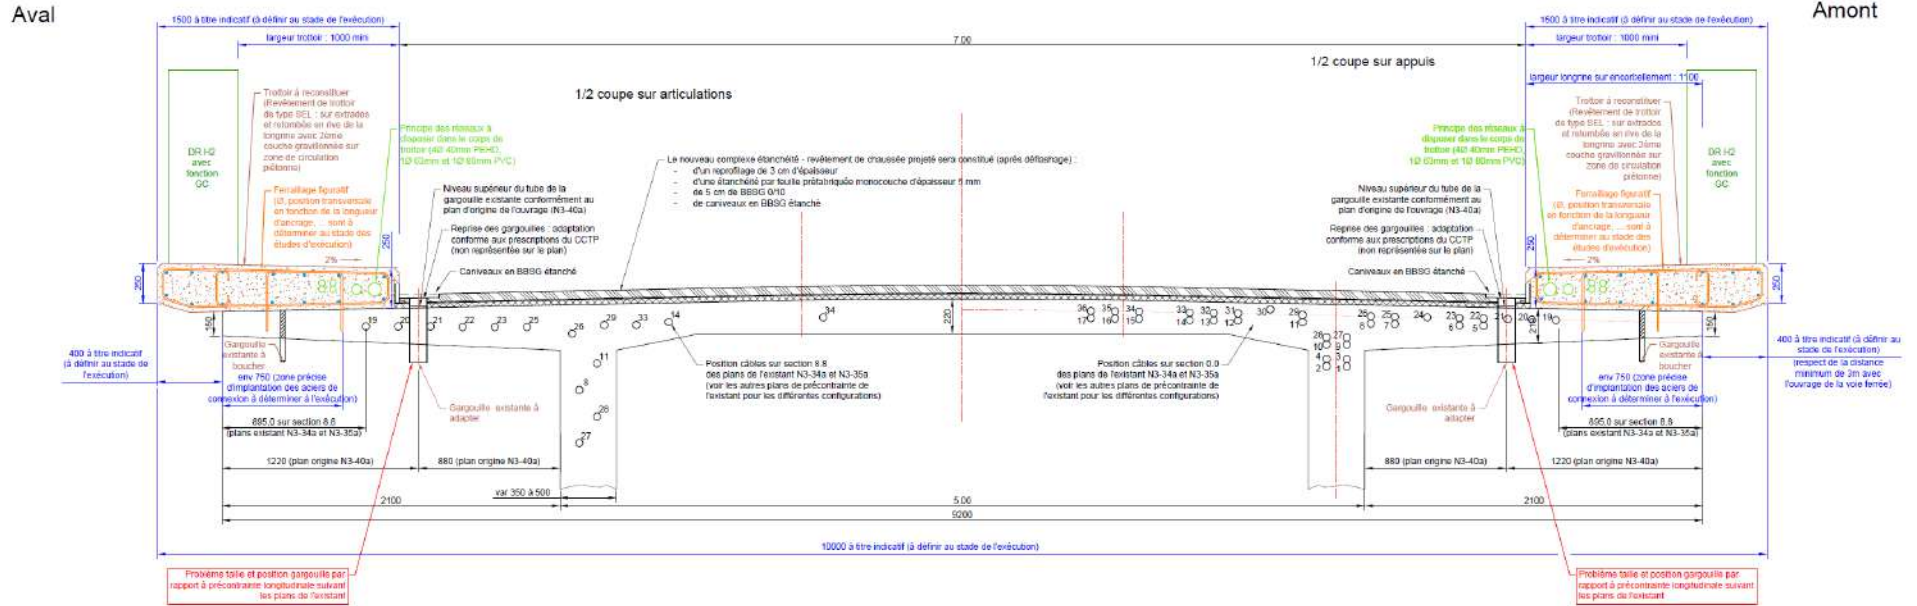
Schéma des travaux prévus sur les superstructures - coupe transversale.
